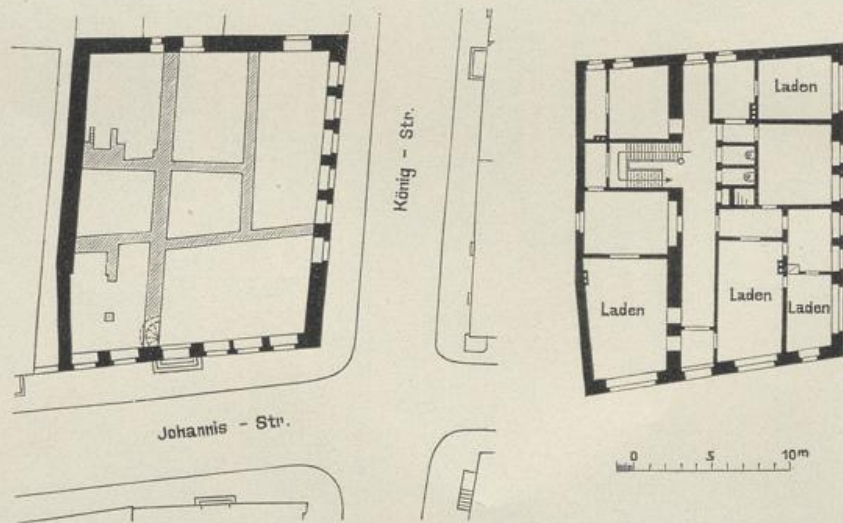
Alter Grundriß mit eingezeichneten Kellermauern.
